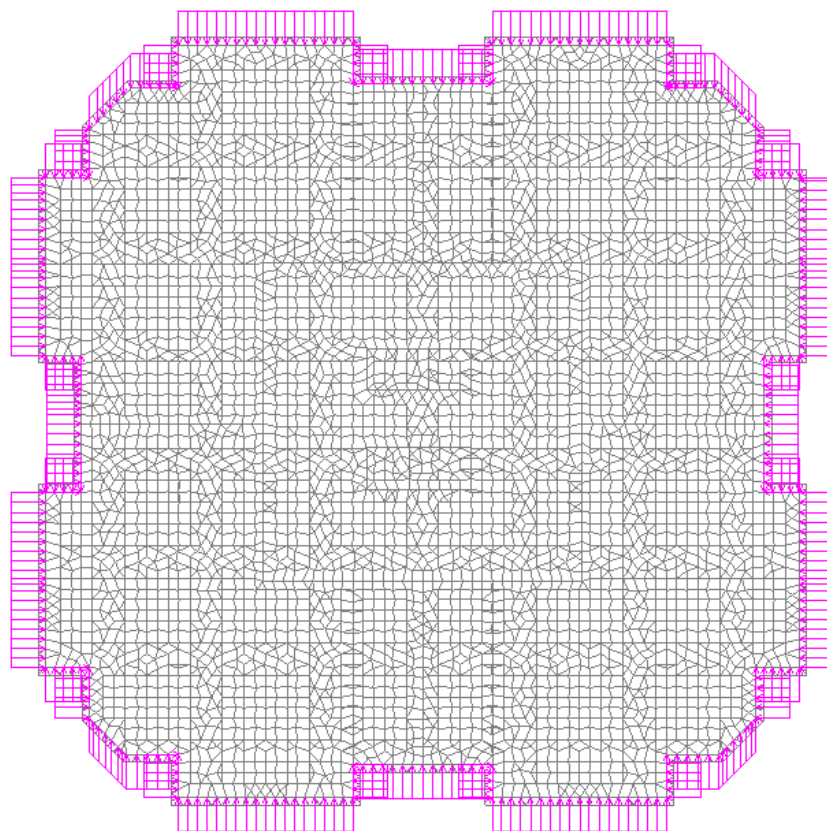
Схема приложения нагрузки от грунта на внешние стены
